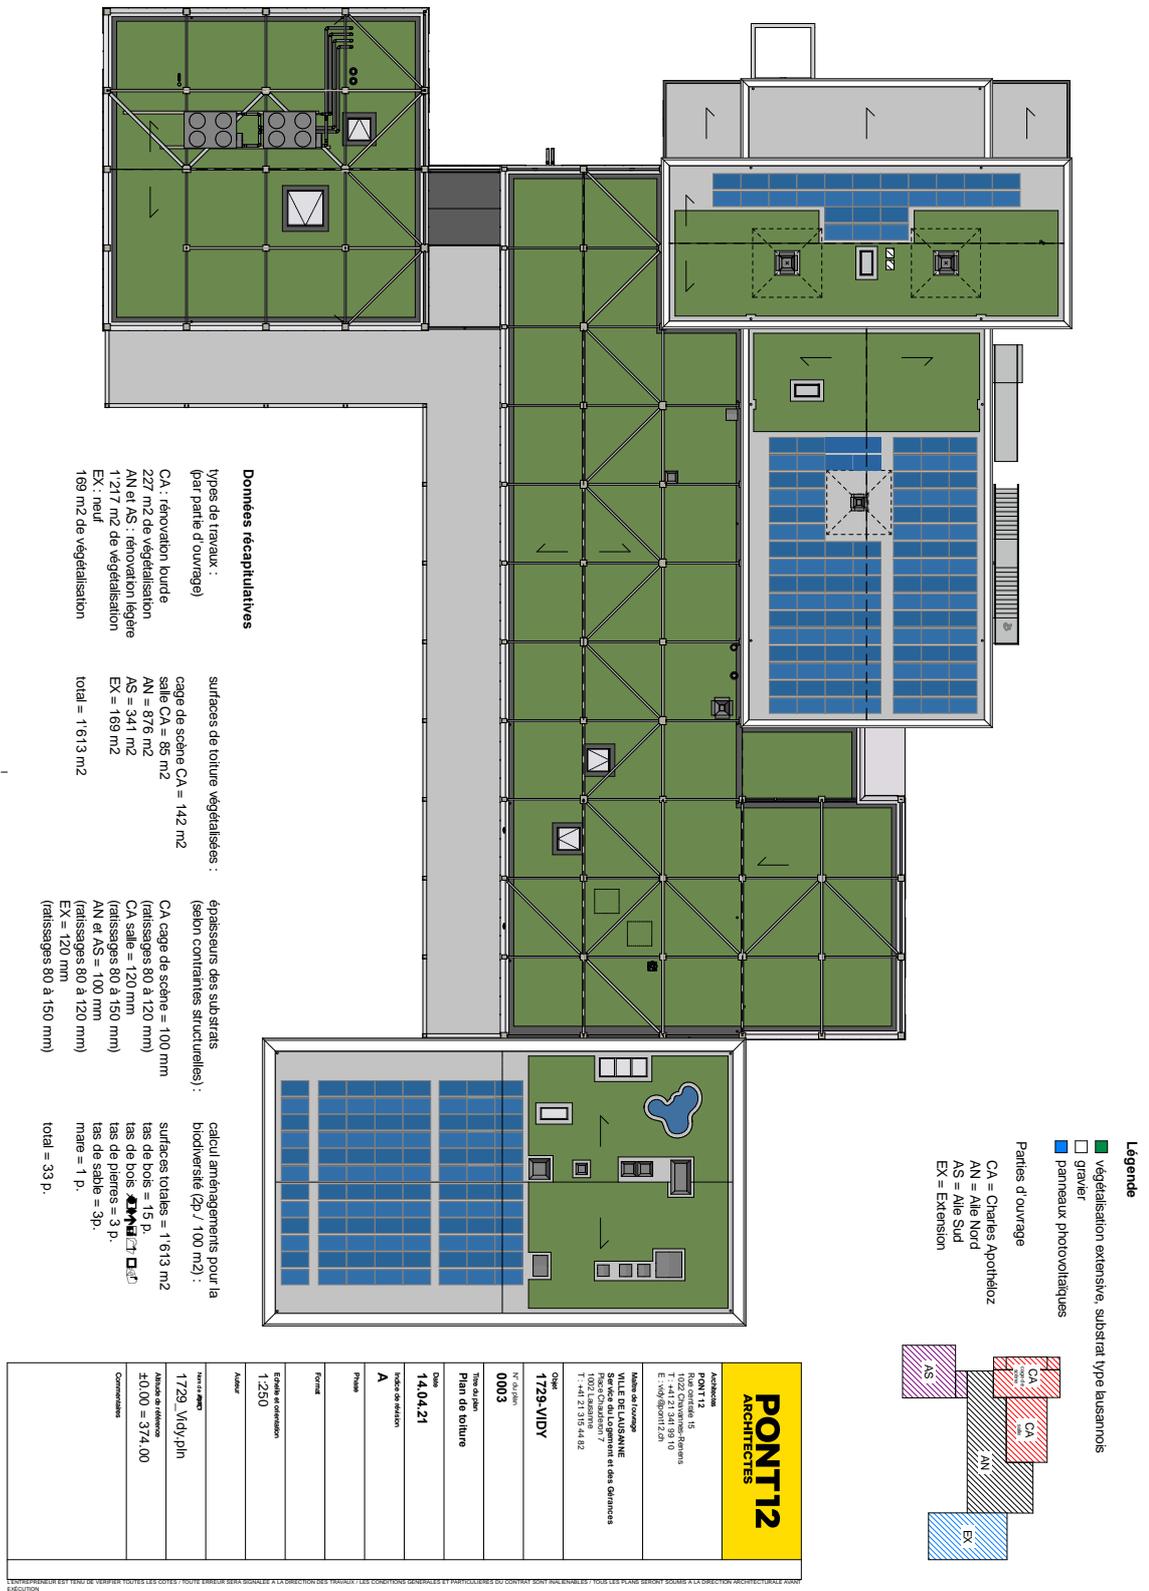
Plan des toitures du Théâtre de Vidy (PONT 12 architectes)
